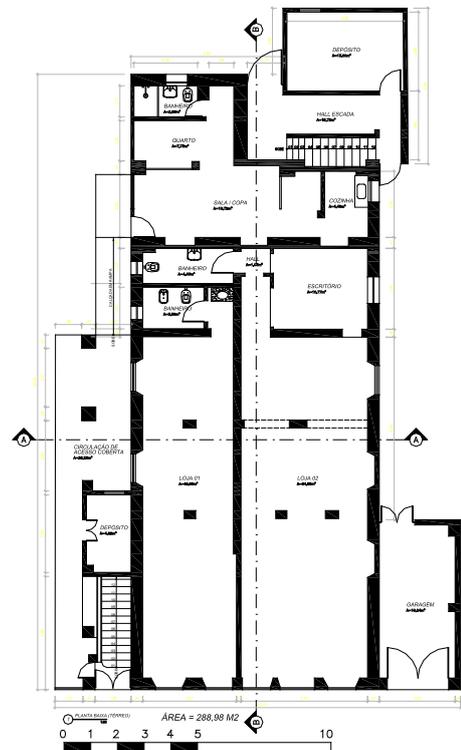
Planta primeiro pavimento - Casa Ney Rambalducci
